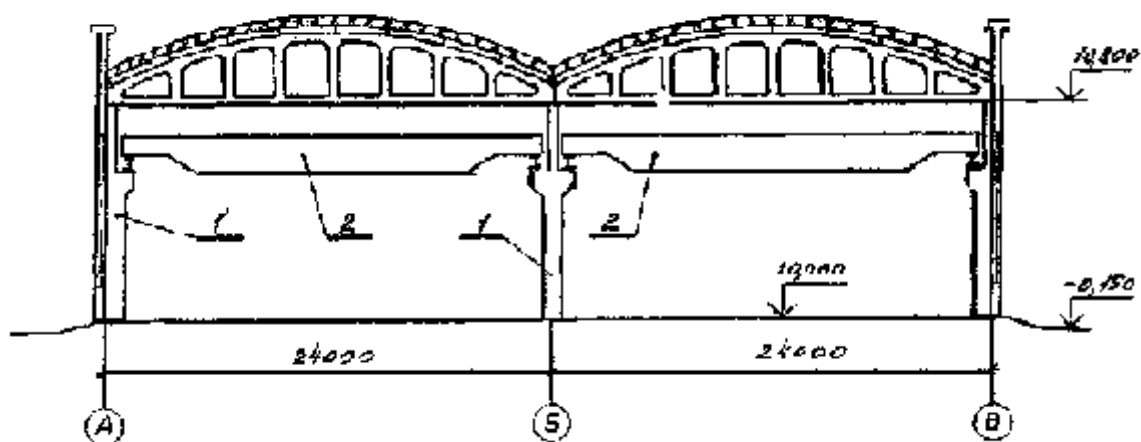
Поперечный разрез одноэтажного двухпролетного промышленного здания:
